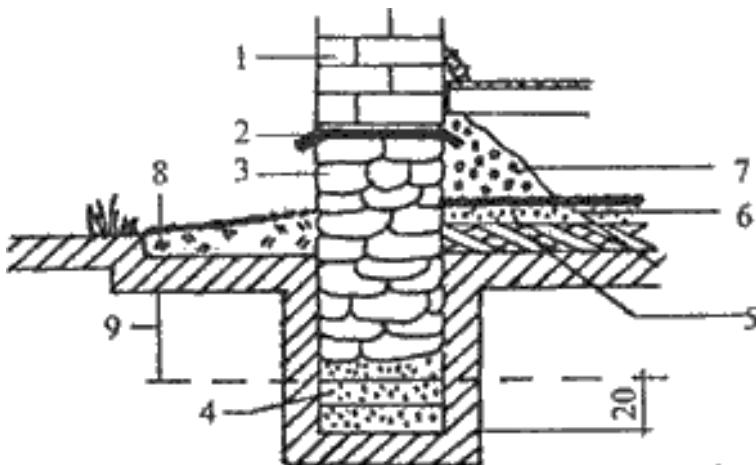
Ленточный фундамент из бутового камня: 1 — кирпичная кладка стены; 2 — гидроизоляция; 3 — бутовый камень; 4 — утрамбованная песчаная подушка; 5 — уплотненный грунт; 6 — песок; 7 — засыпка; 8 — отмостка; 9 — глубина промерзания.
